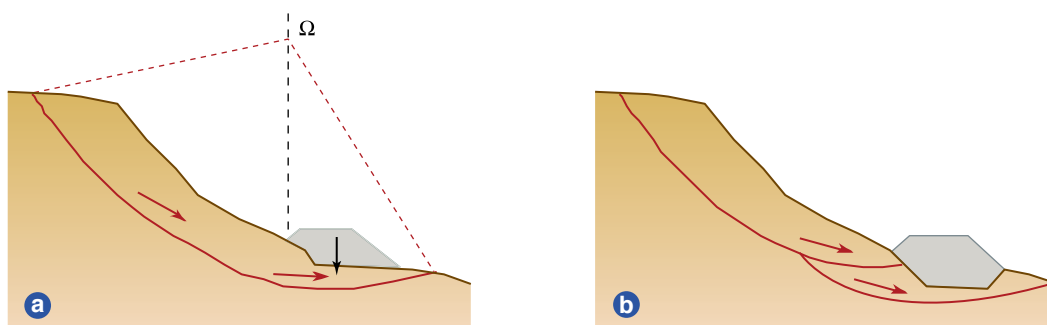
Exemples de remblais de chargement de pied (a) et de butée de pied (b)
